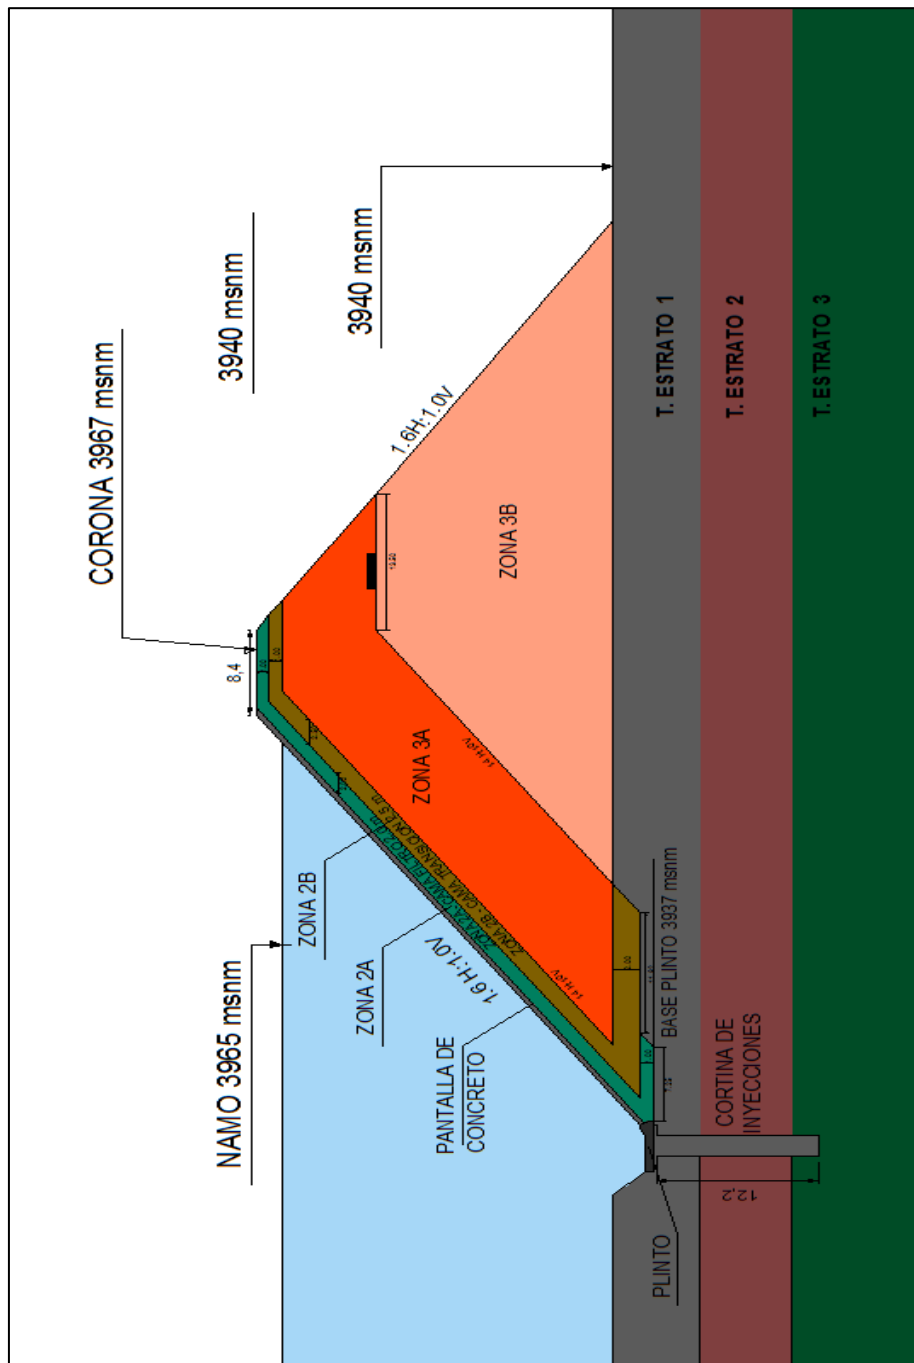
Sección típica de presa de enrocado con pantalla de concreto
